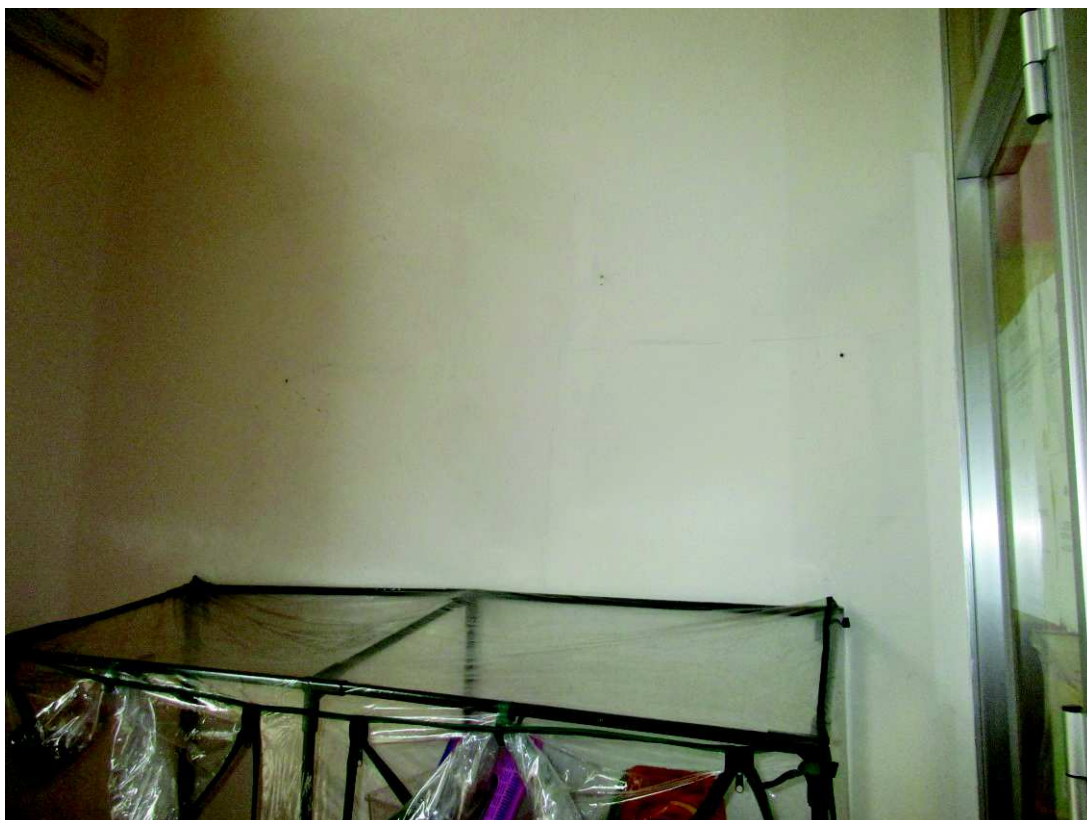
all'ingresso piccola fessura verticale sulla parete portante interna lato ovest
